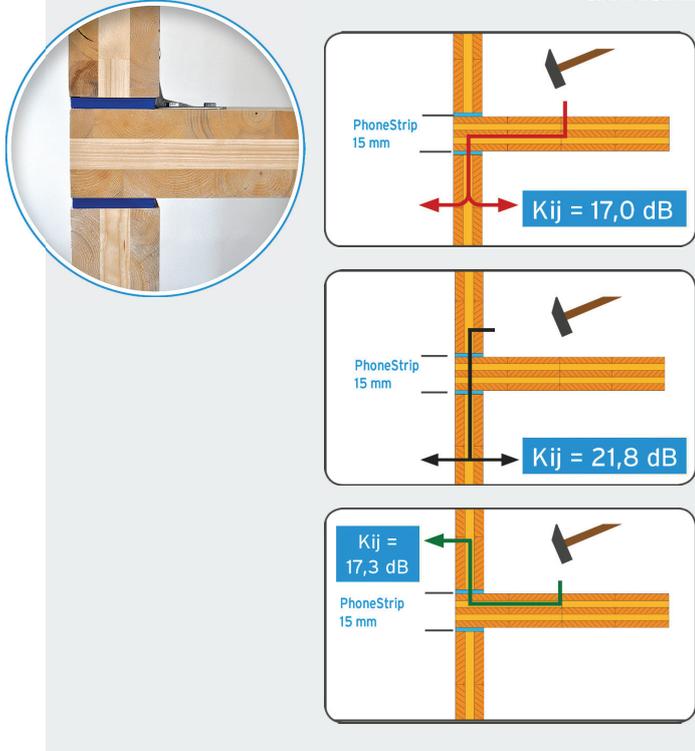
Bei einem T-Stoß sind drei Übertragungswege möglich: Decke ↔ Untere Wand, Obere Wand ↔ Untere Wand und Decke ↔ Obere Wand.
